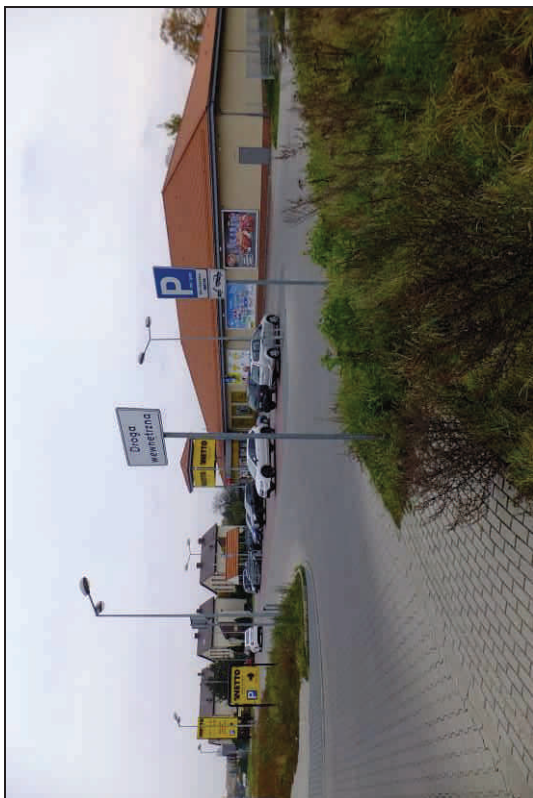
Widok w kierunku zachodnim, ul. Jaśkowicka
